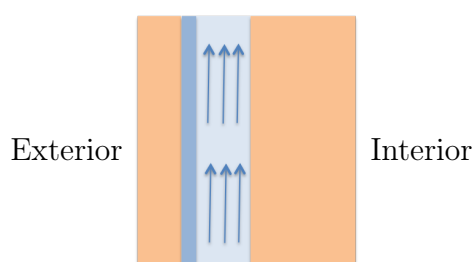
Esquema de fachada compuesta por: Elemento exterior masivo con aislante hacia la cámara, muro interior masivo.
